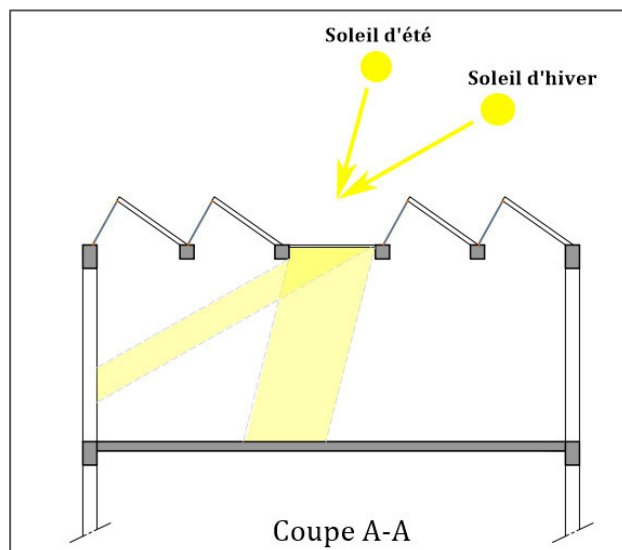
Coupe A-A sur la salle d'exposition. (Source : auteur)
